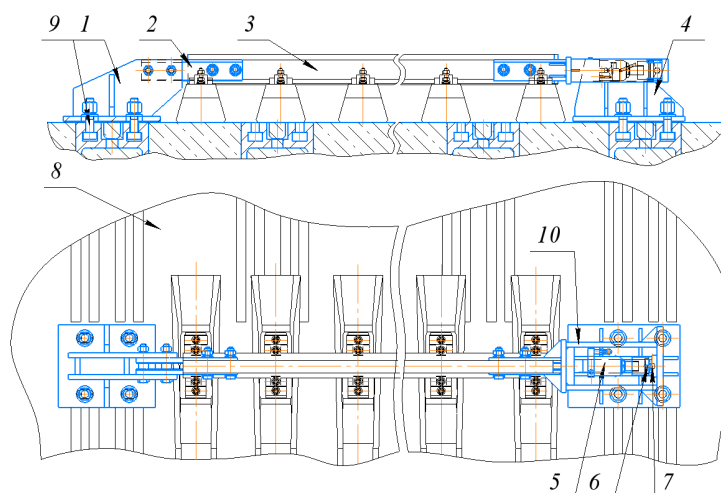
Схема стенда для испытаний рельсошпальной решетки на растяжение: 1 – кронштейн; 2 – соединительная планка; 3 – рельсошпальная решетка; 4 – упор; 5 – домкрат; 6 – датчик силы; 7 – шарик; 8 – поверхность пола; 9 – болты крепления стенда; 10 – тяга
